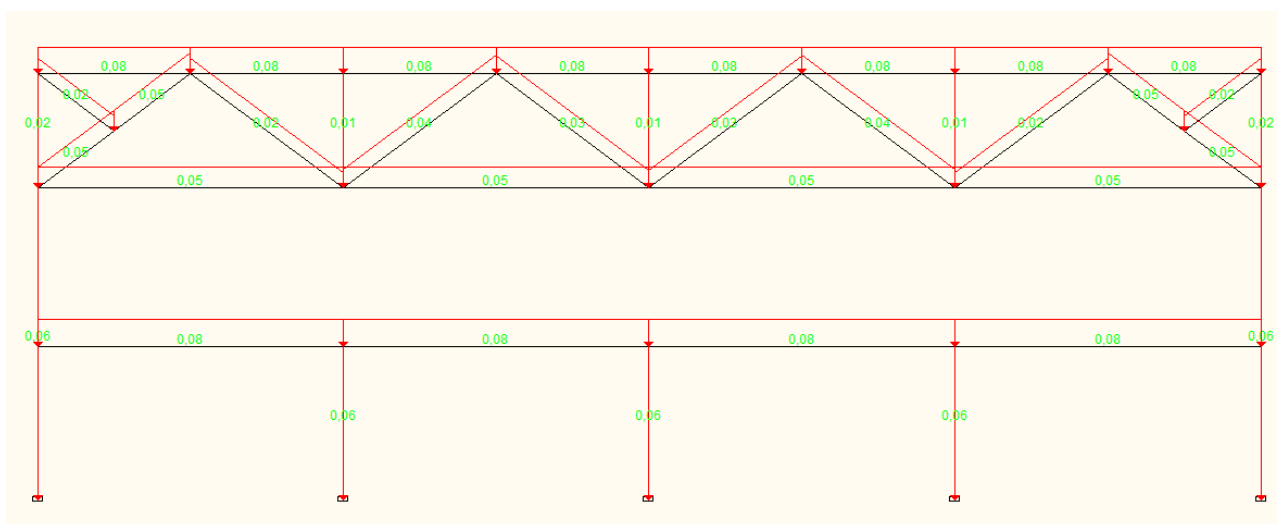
Схема приложения нагрузки собственного веса металлических конструкций
